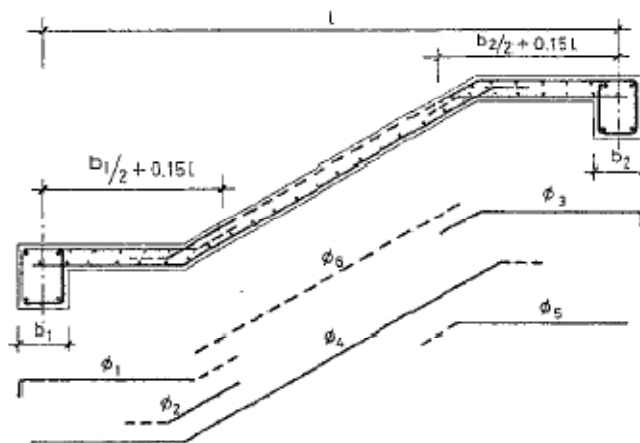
Detalle de armado de una escalera longitudinal.
